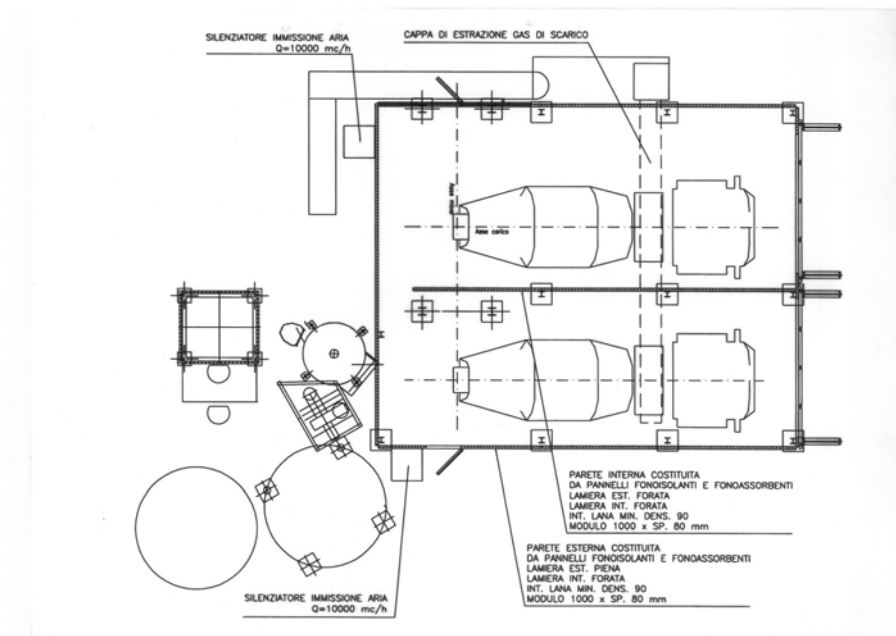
Layout insonorizzazione impianto di betonaggio
